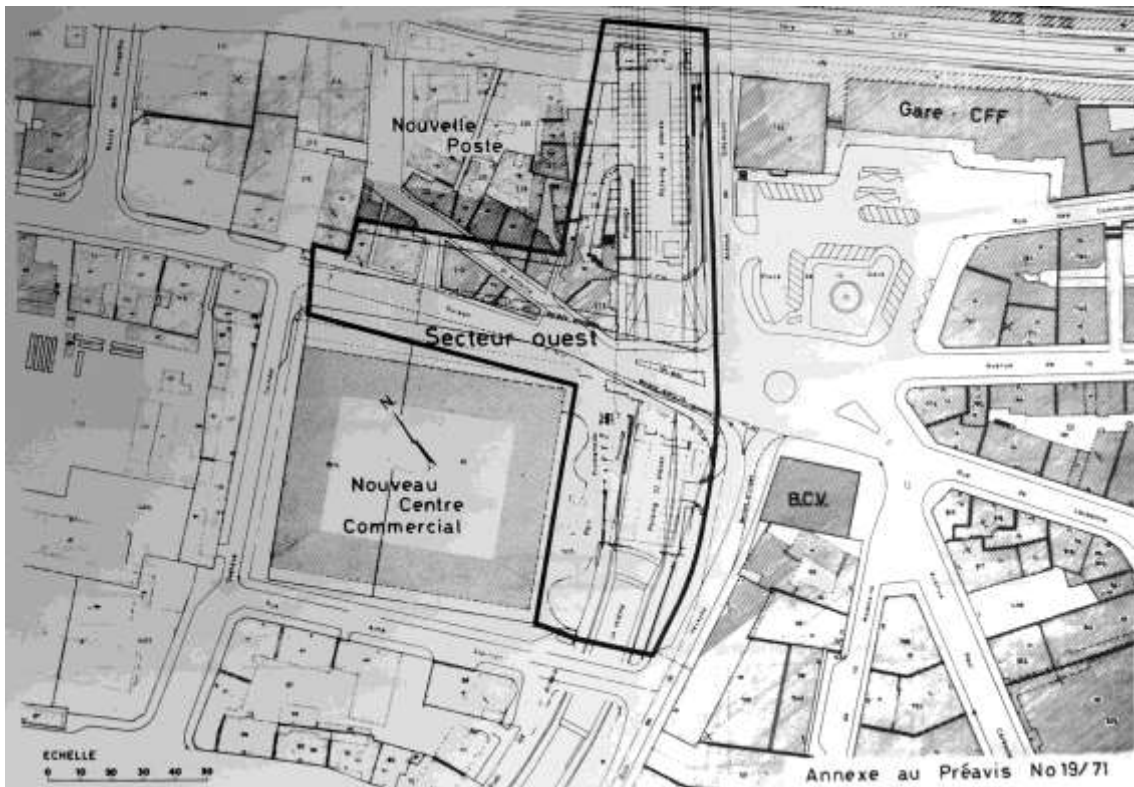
Plan de la place de la Gare, secteur ouest, préavis du Conseil municipal du 1.7.1971 (AV 42.24 Place Gare).
